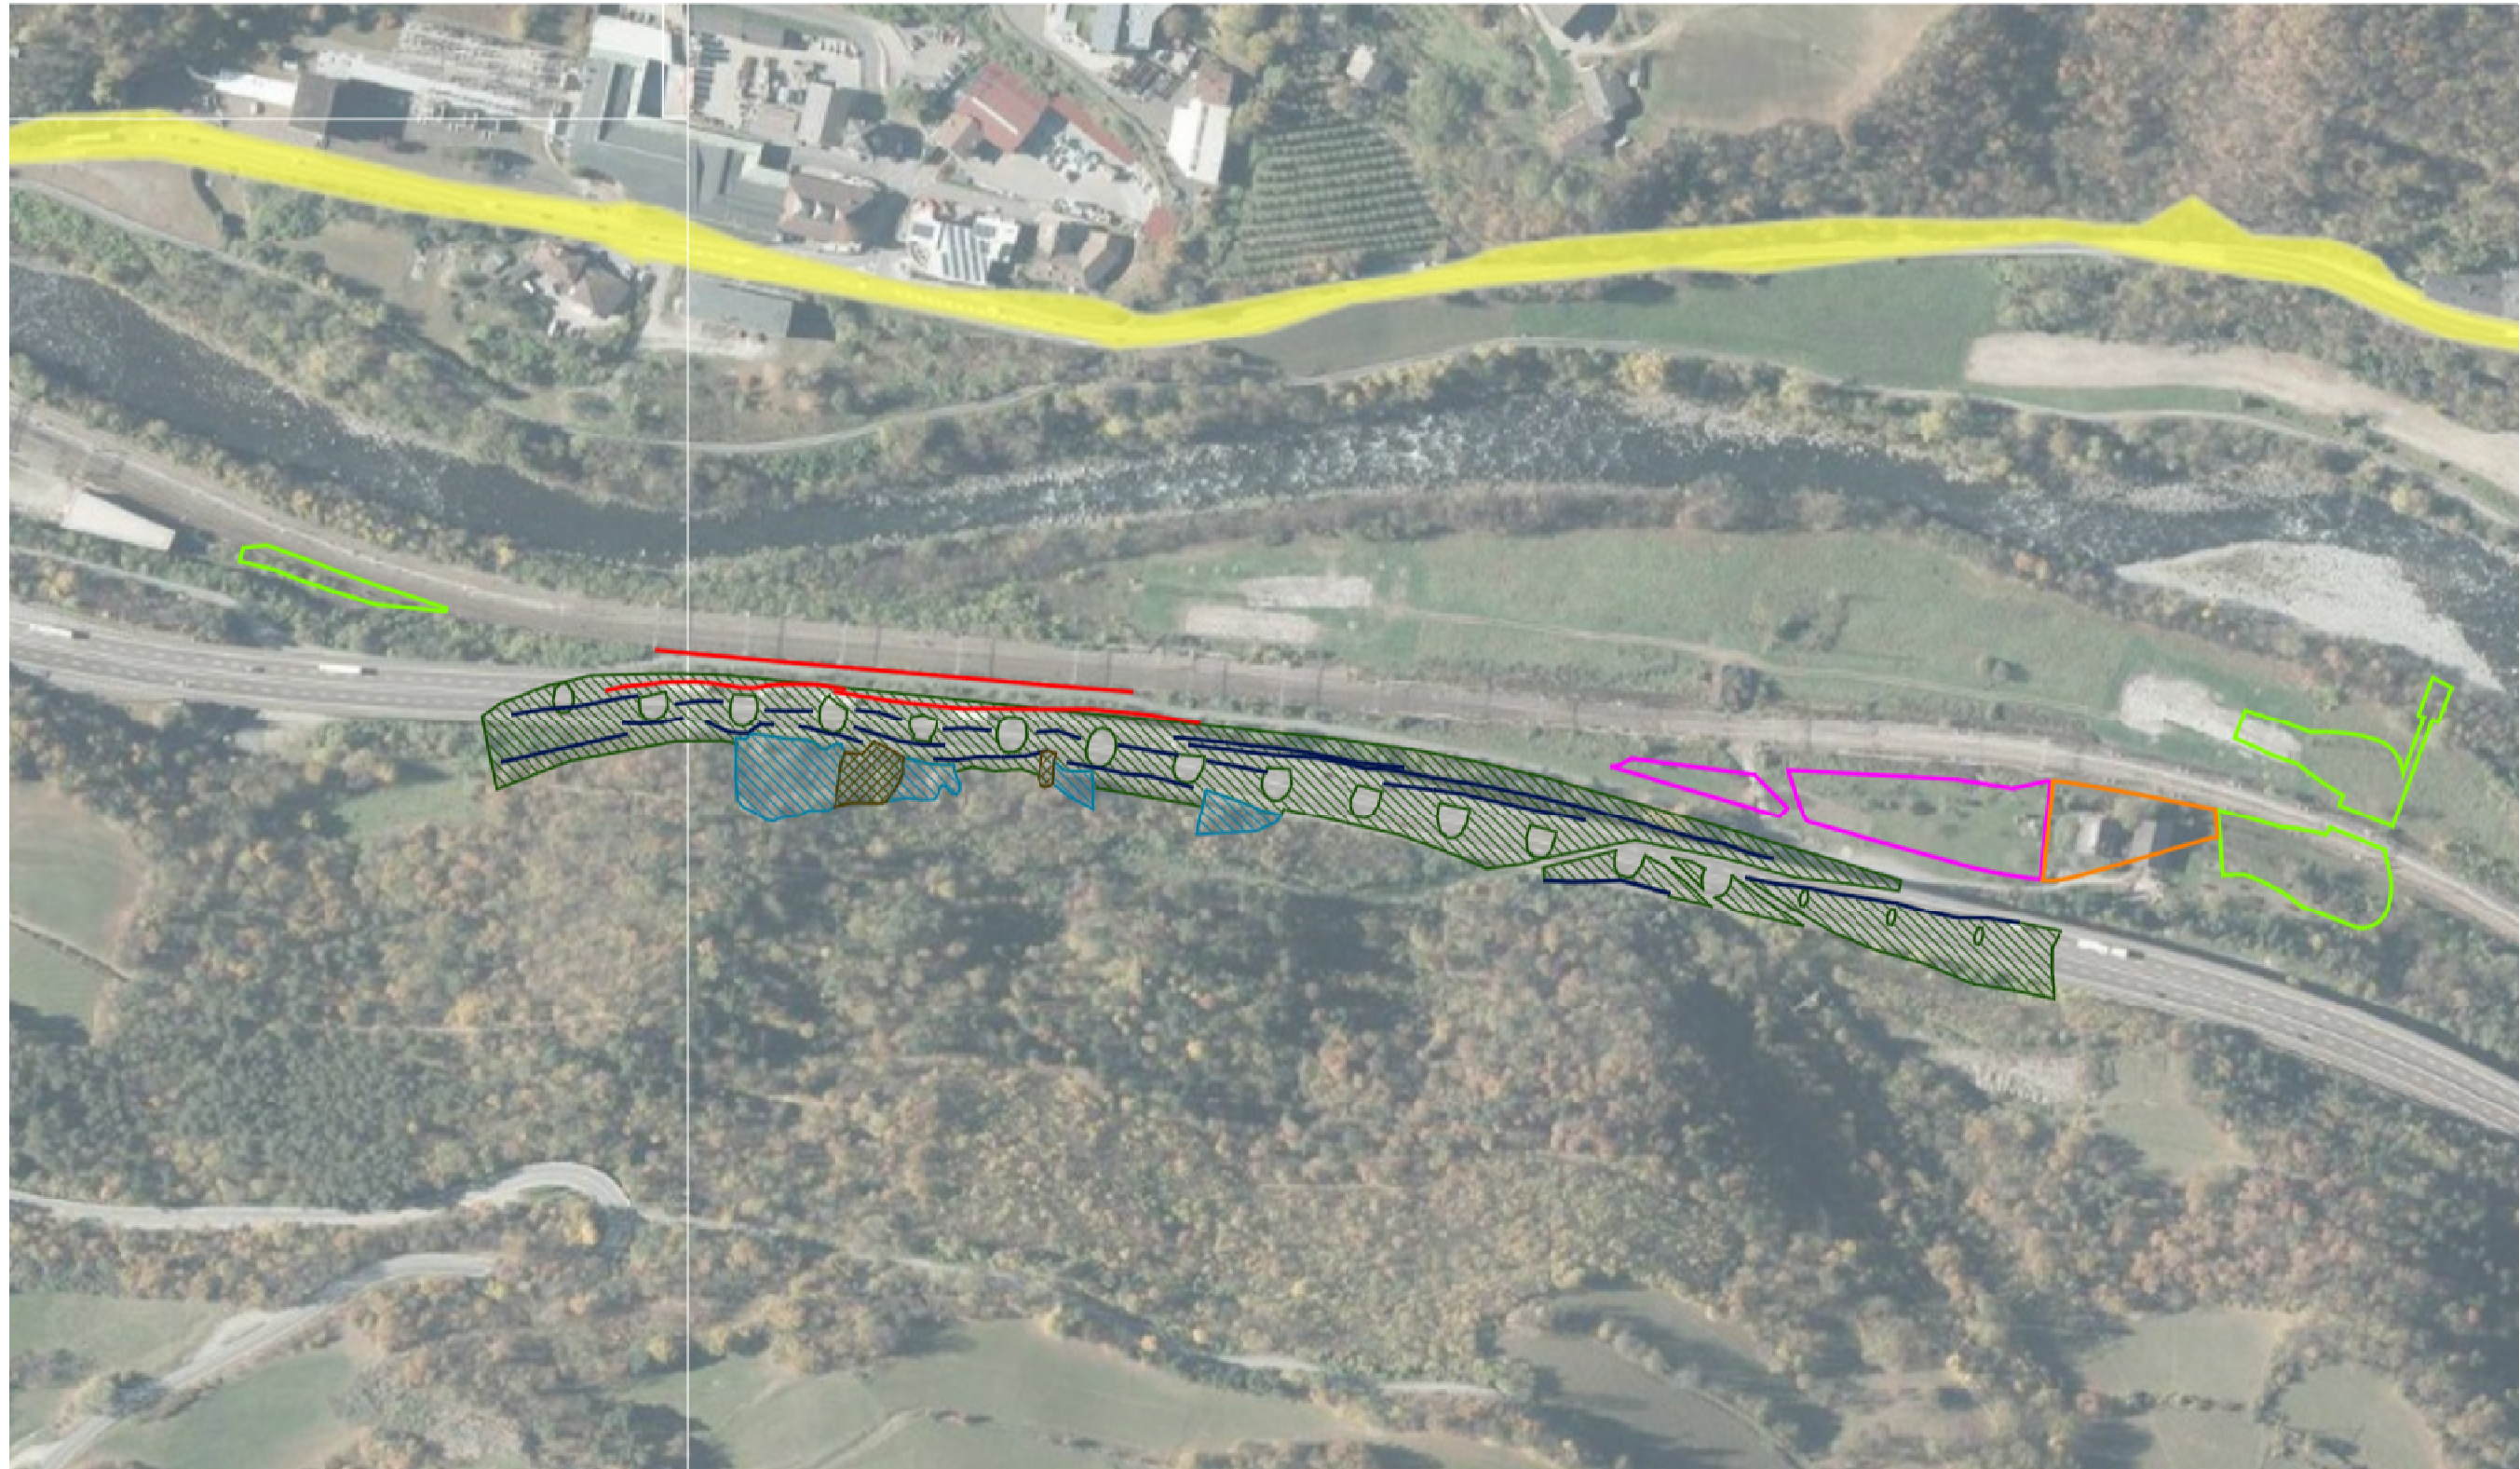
zone archeologiche . – mappa con sovrapposizione delle opere in progetto e cantieri
